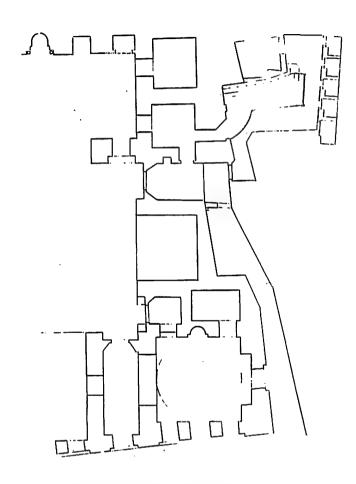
مسقط أفقى لمدرسة وقبة السلطان حسن عن فراترباشا
